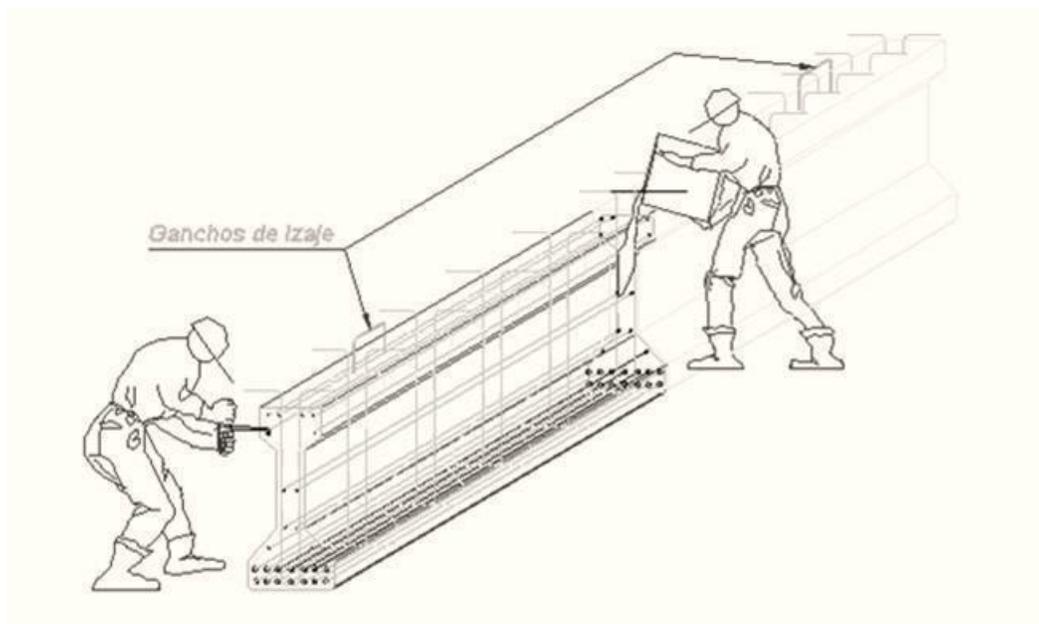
Trazo de la estructura y fabricación de traveses.
